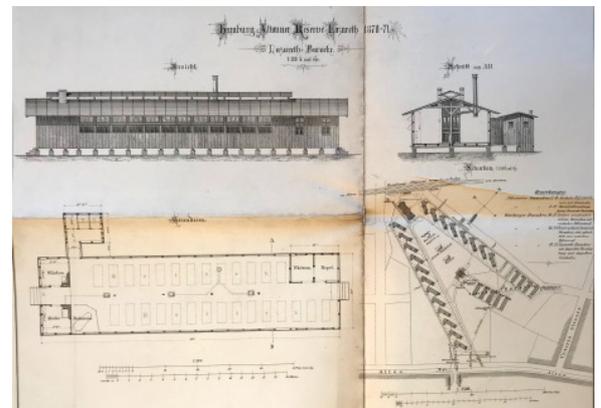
Grundplan des Altonaer Barackenlazarett, aus StAHH 1111-1_6757
